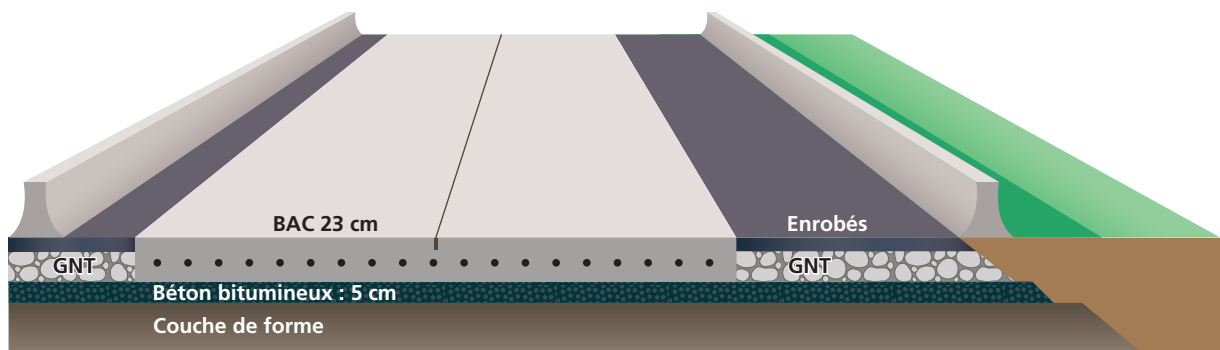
exemple de profil en travers d'une chaussée en béton armé continu (BAC)
